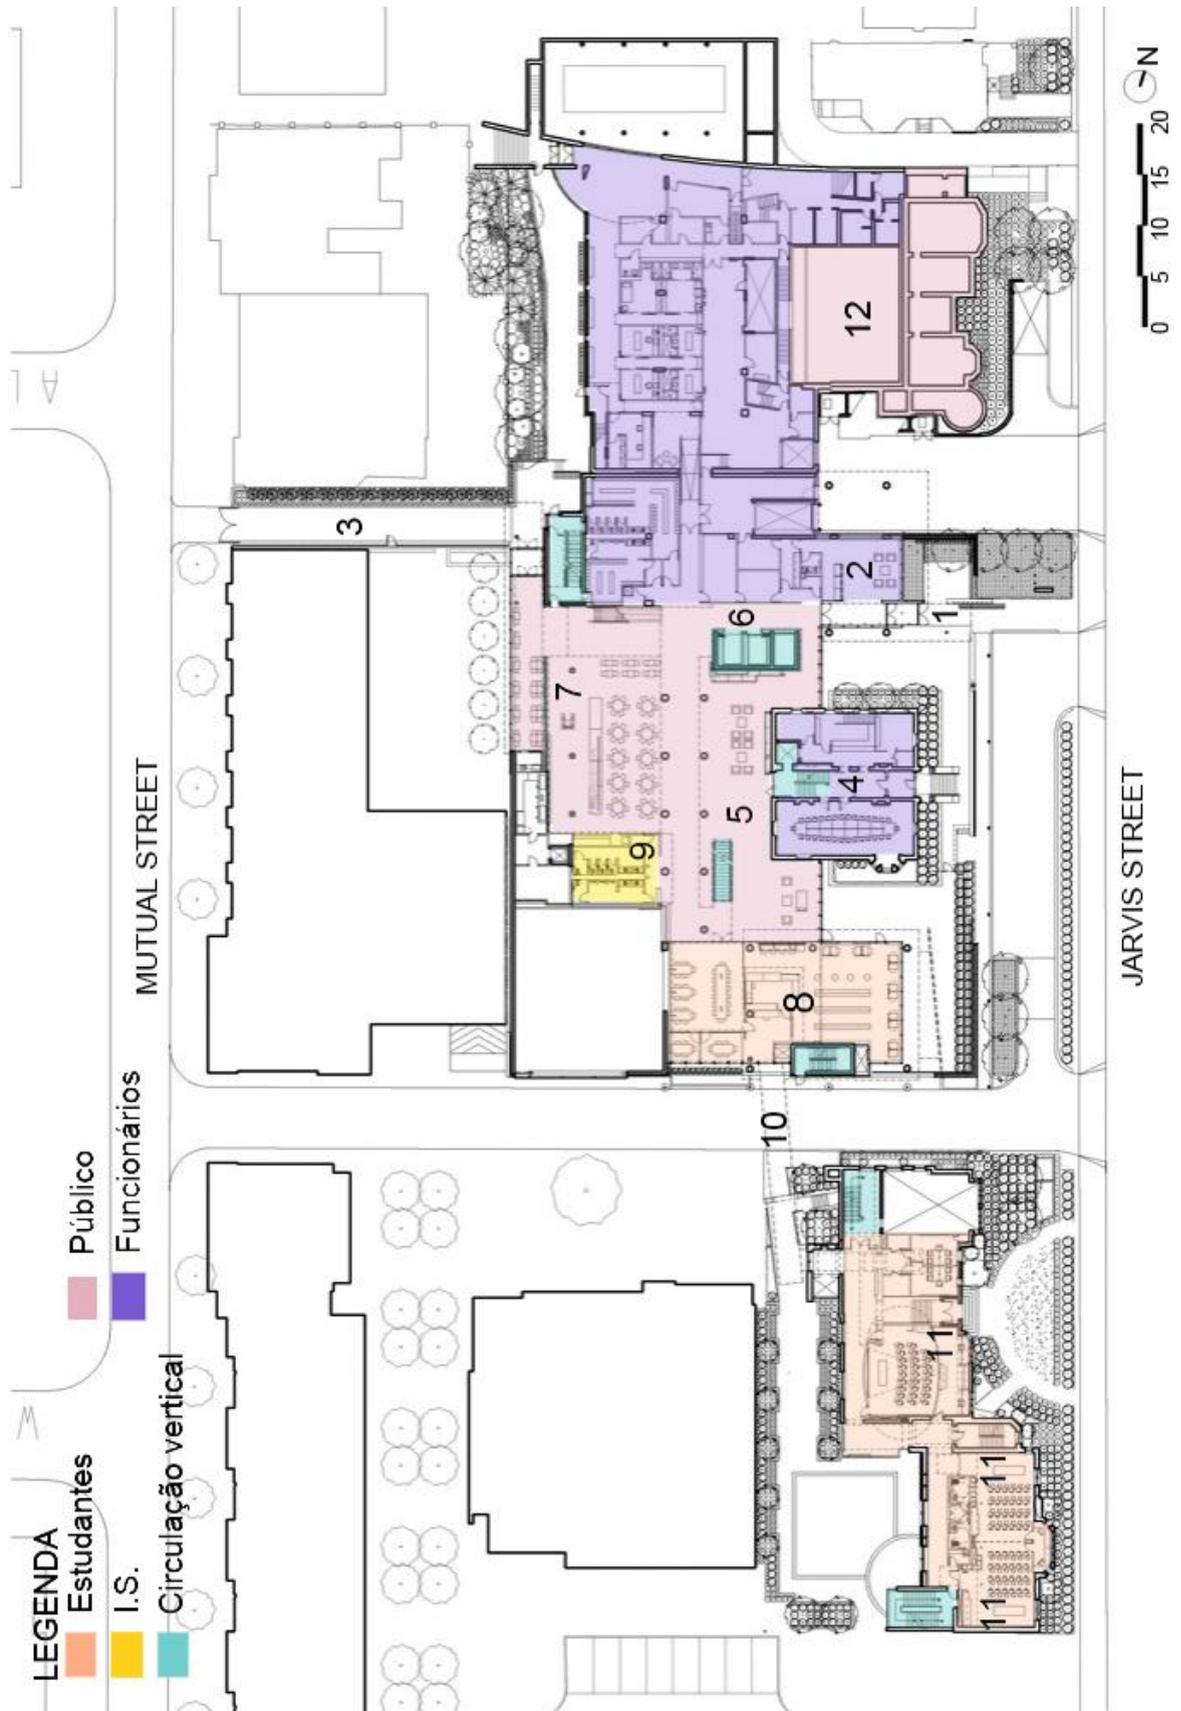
PLANTA PAVIMENTO TÉRREO - ESCALA GRÁFICA
